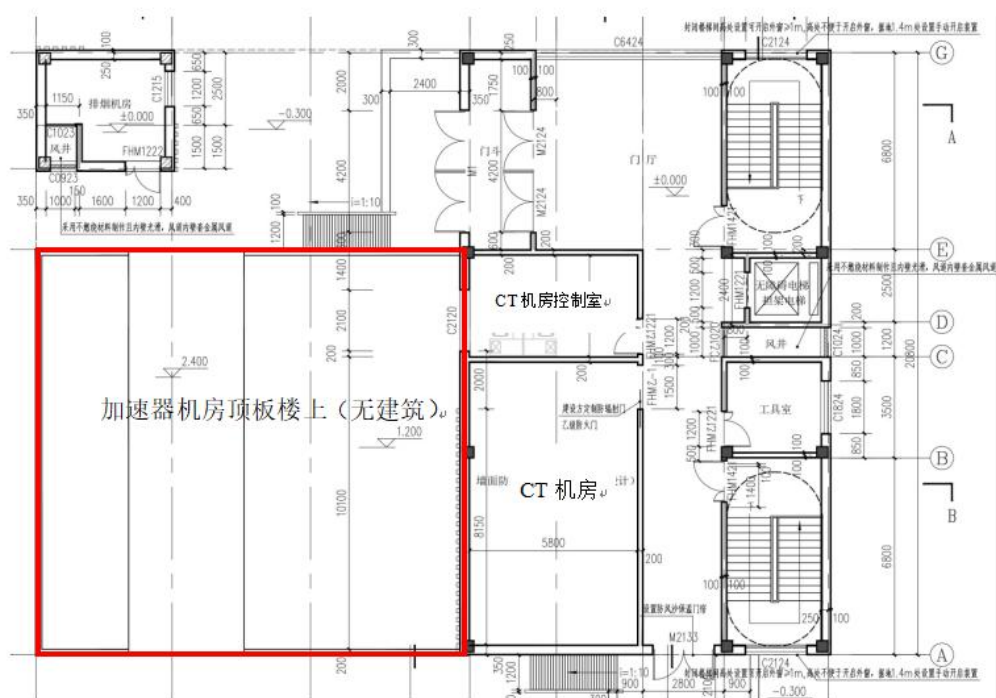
肿瘤综合治疗中心首层平面布置图（加速器机房楼上）
